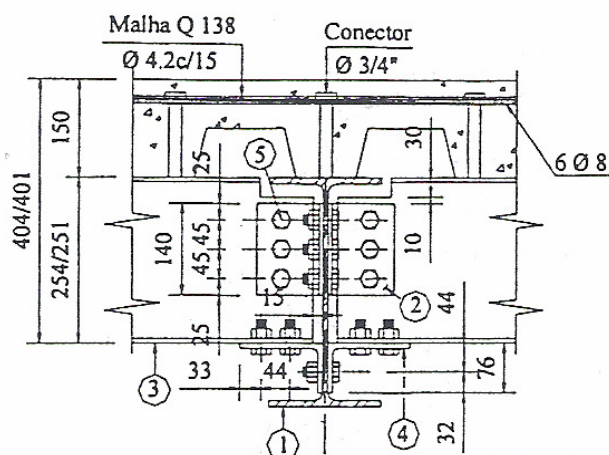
Ligação semirrígida entre as vigas secundárias (VS e VS_b) e a viga principal (VP) – corte CC [38]
